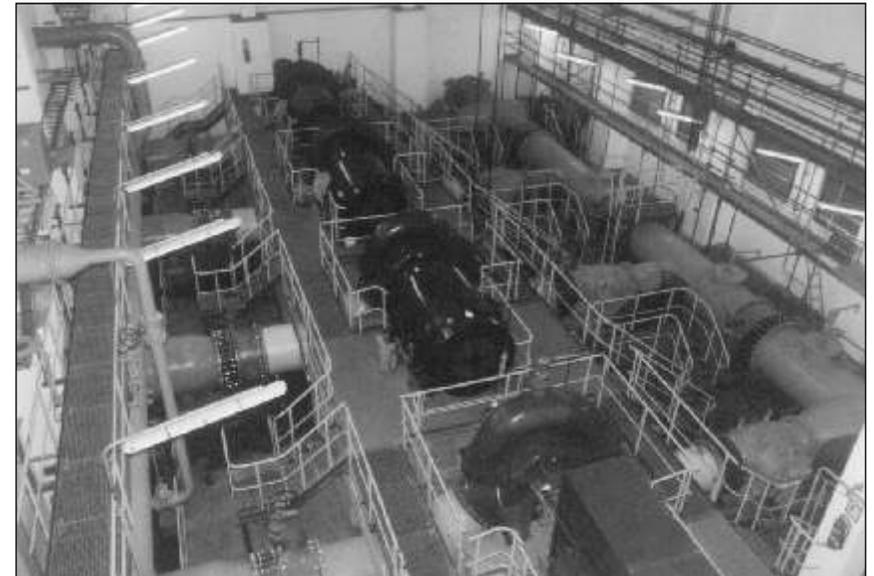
Rekonstruiertes Pumpenhaus RKW L 119
